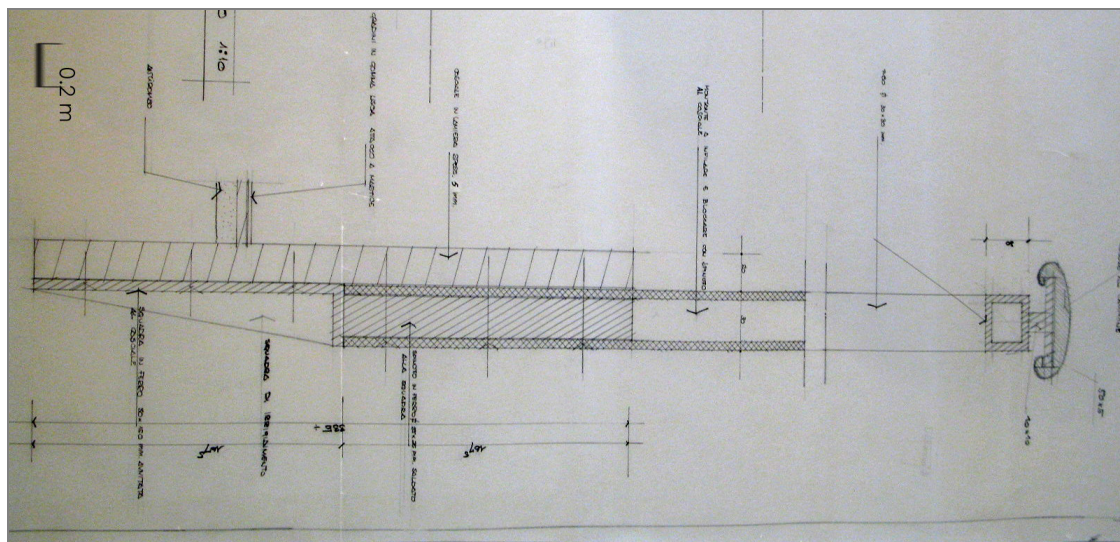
parapetto sciala a tenuta di fumo - (fonte CSAC – stralcio tav. 47, archivio n. 234-1)
